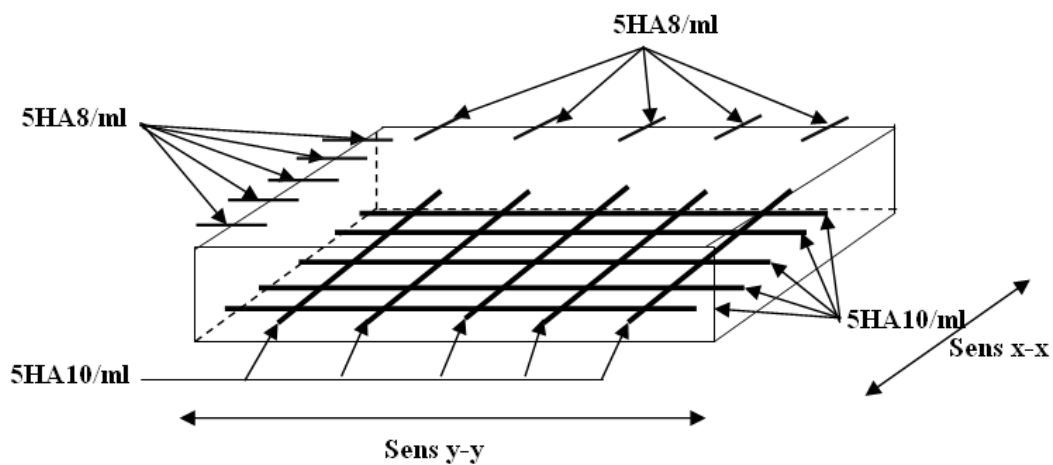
Schéma de ferrailage de la dalle pleine du local machinerie
